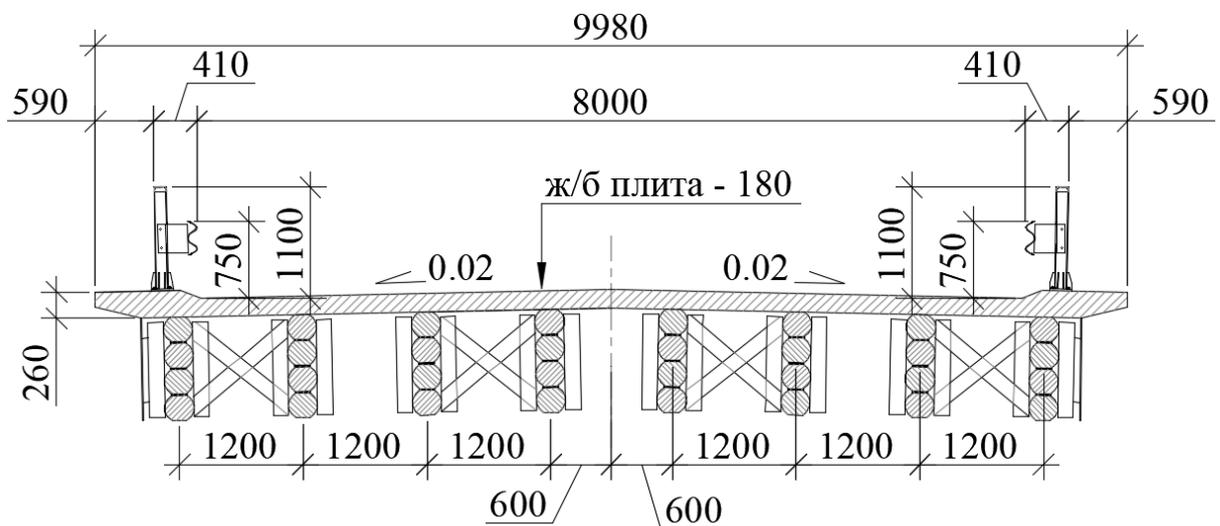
Поперечное сечение пролетного строения моста через р. Нягов длиной 15 м с составными прогонами из бревен и монолитной железобетонной плитой
